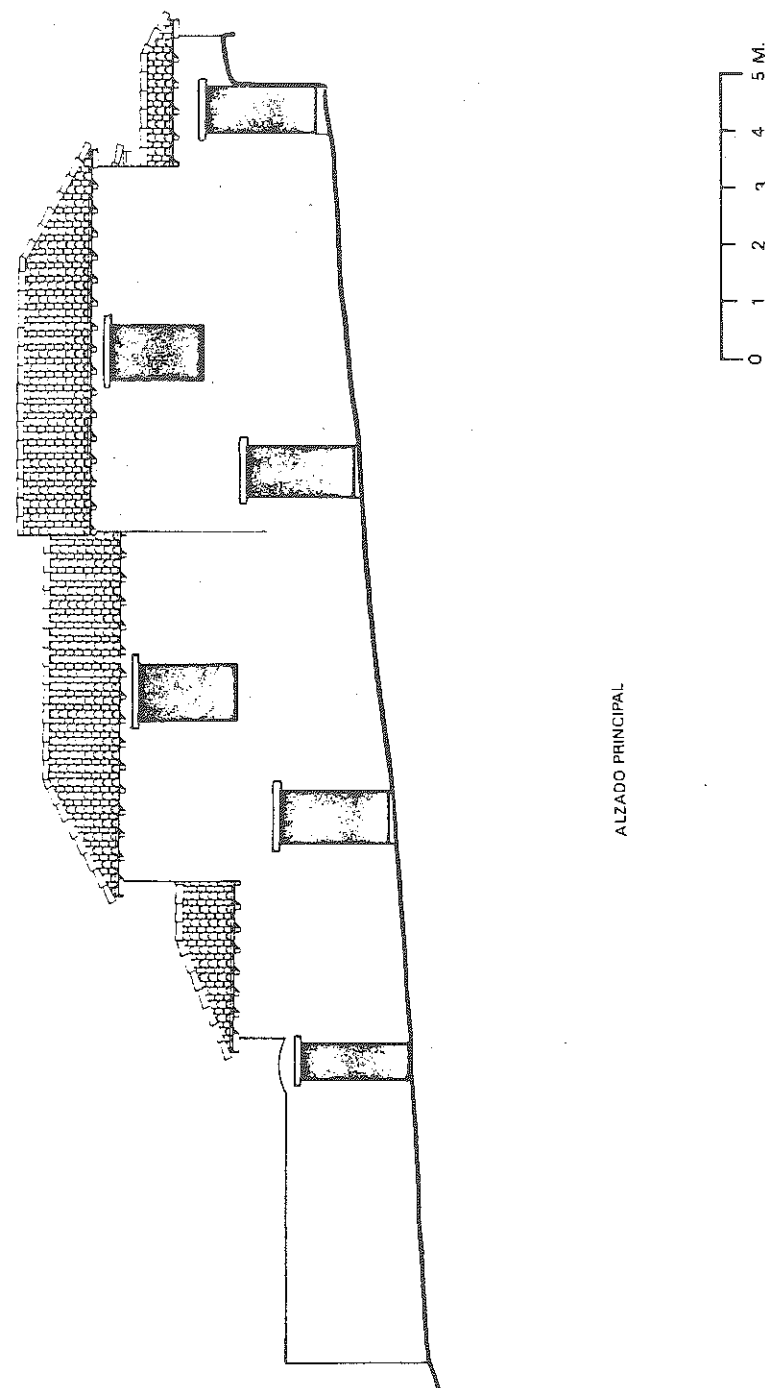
Alcazaba de Málaga. Barrio de casas árabes. Alzado principal de las casas 2 y 4 (según R. Puertas Tricas).
